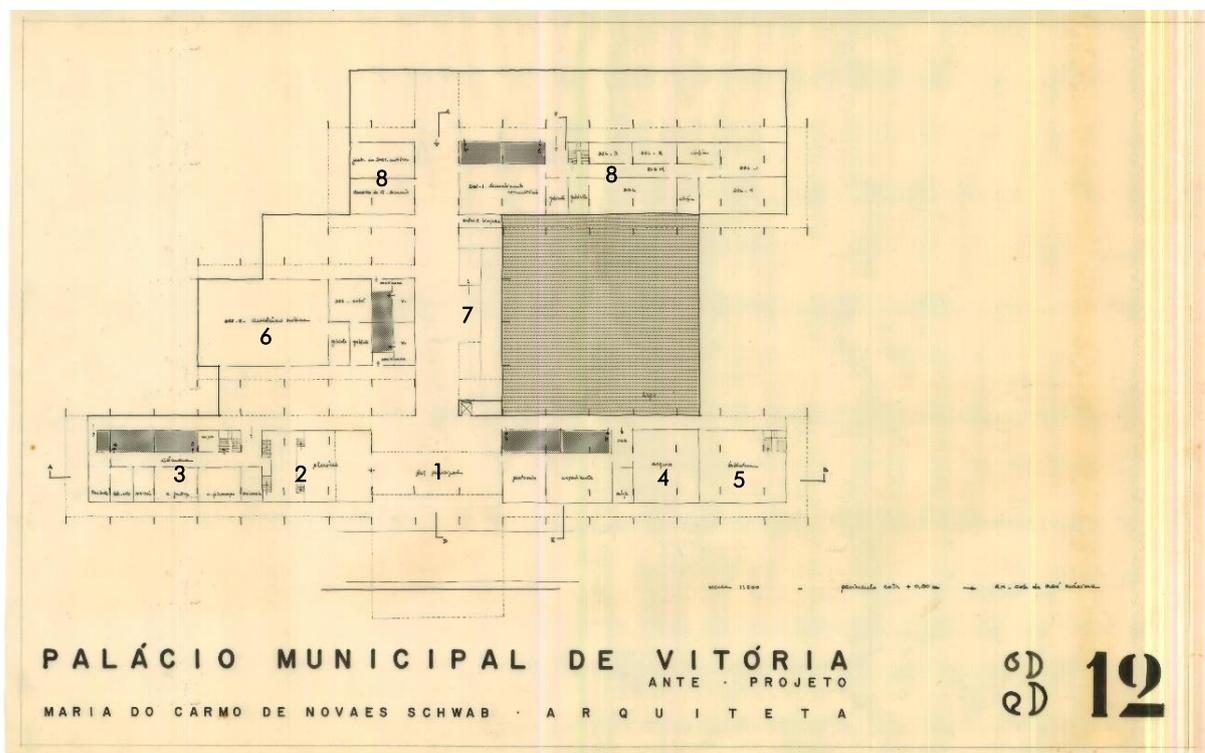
Prancha 3/12, constando planta-baixa esquemática referente ao pavimento semienterrado, destacando-se o acesso sob a marquise na fachada principal e a relação entre os 3 blocos propostos. Programa - setores: 1. Hall de entrada; 2. Plenário; 3. Câmara; 4. Arquivo; 5. Biblioteca; 6. Assistência médica; 7. Rampa; 8. Salas departamentais. Fonte: acervo Maria do Carmo Schwab, reunido e organizado por Clara Miranda.
